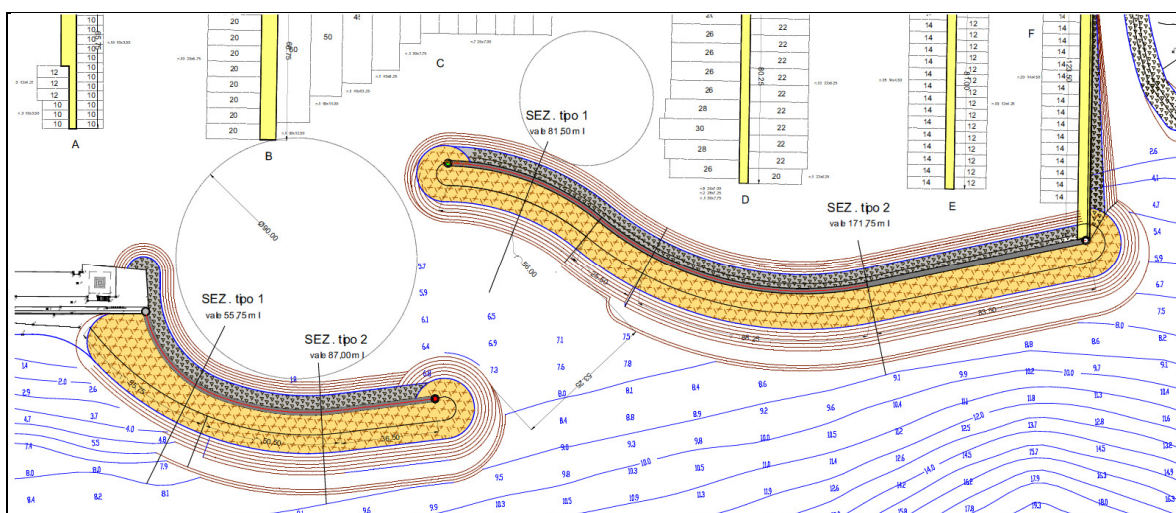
Planimetria opere foranee e localizzazione sezioni tipo
